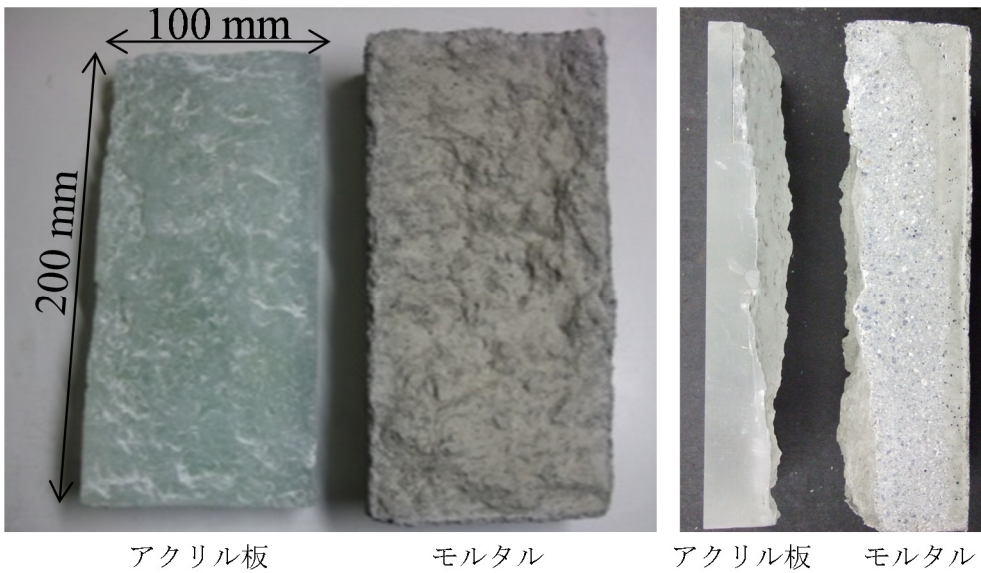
ひび割れ再現試験体（左：切削面，右：側面）
